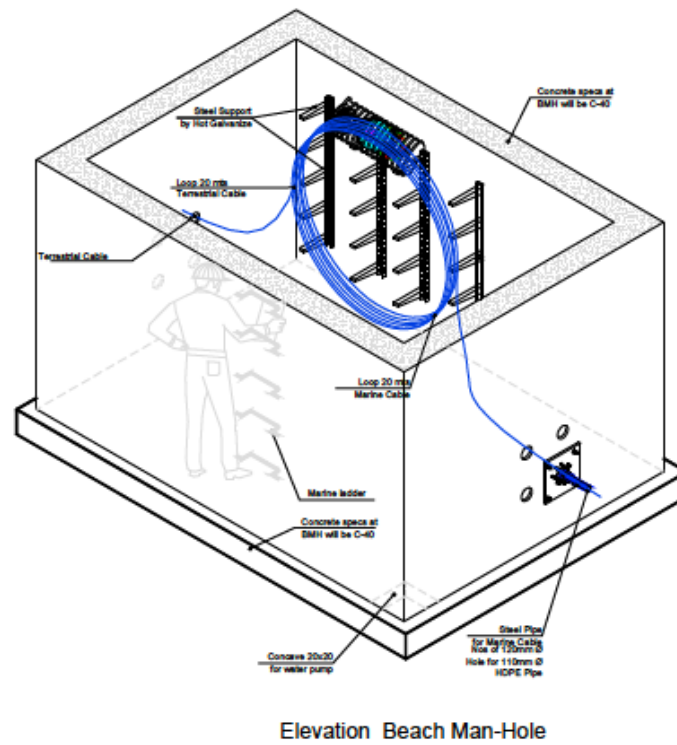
CONEXIÓN DE CABLE DE FIBRA ÓPTICA EN EL REGISTRO DE AMARRE EN PLAYA (BEACH MANHOLE)
